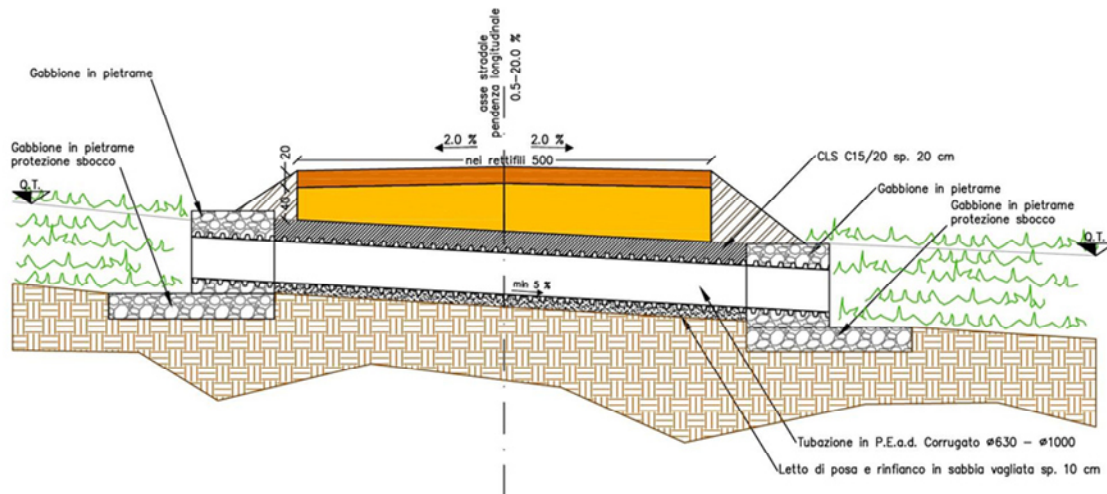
particolare tipo tombini in progetto con opere di protezione
